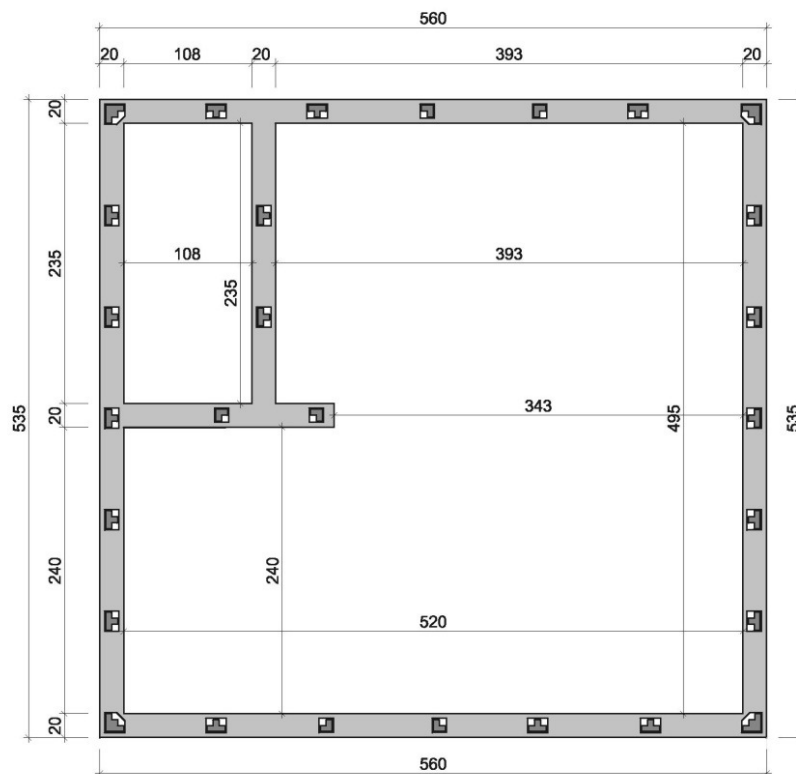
Planta baixa das vigas de fundação do projeto da residência de 29,13m².
